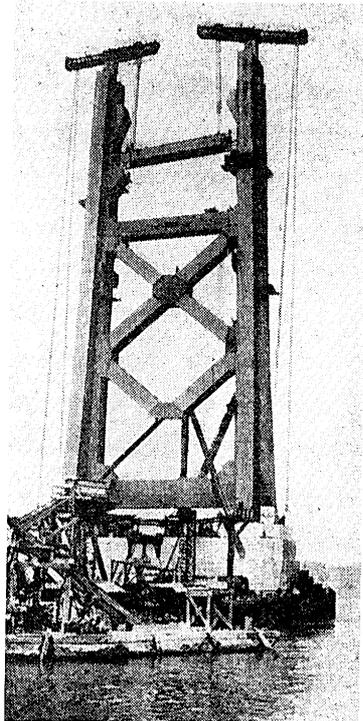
Oakland Bay 橋の架設クレーン
